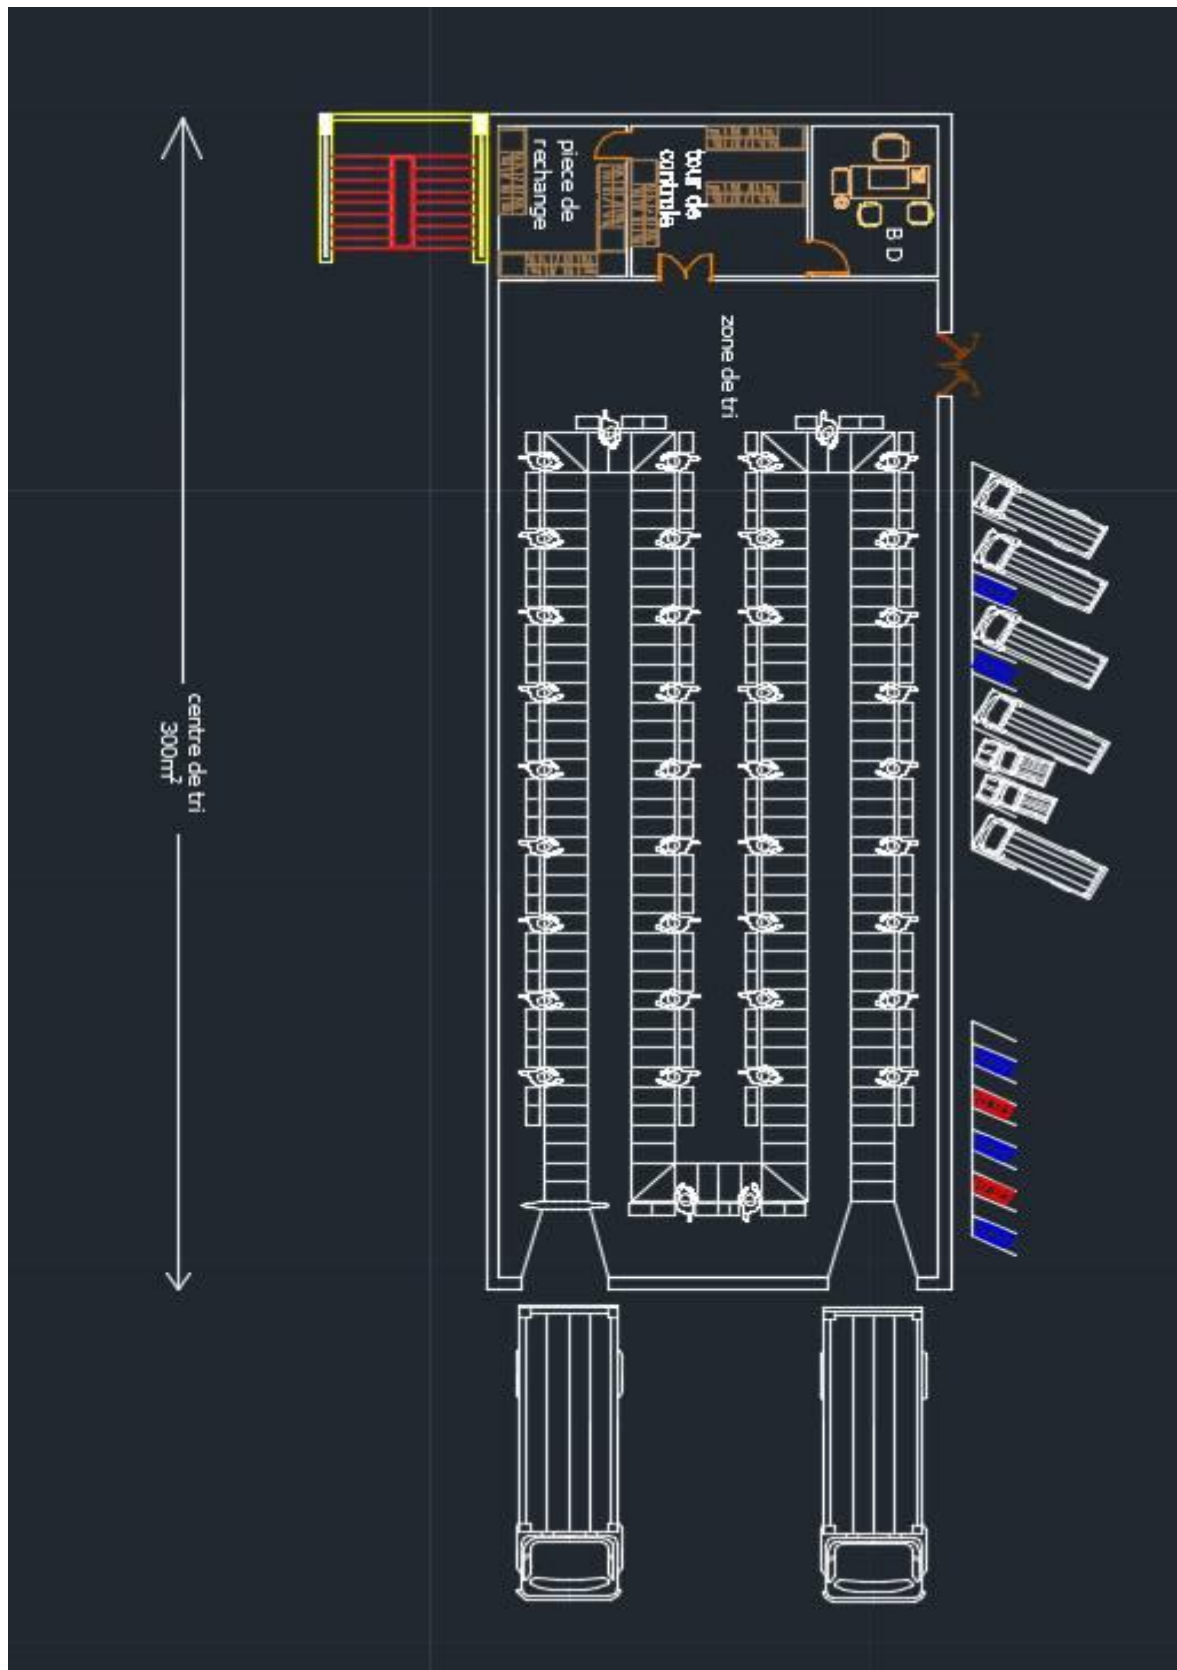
plan de notre centre de tri (1^{er} étage)
